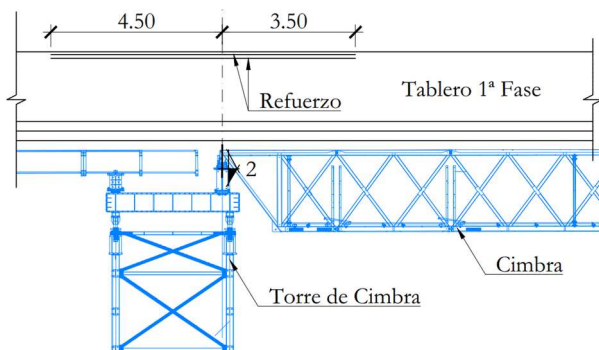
Refuerzo de la primera fase por el hormigonado de la segunda fase.
